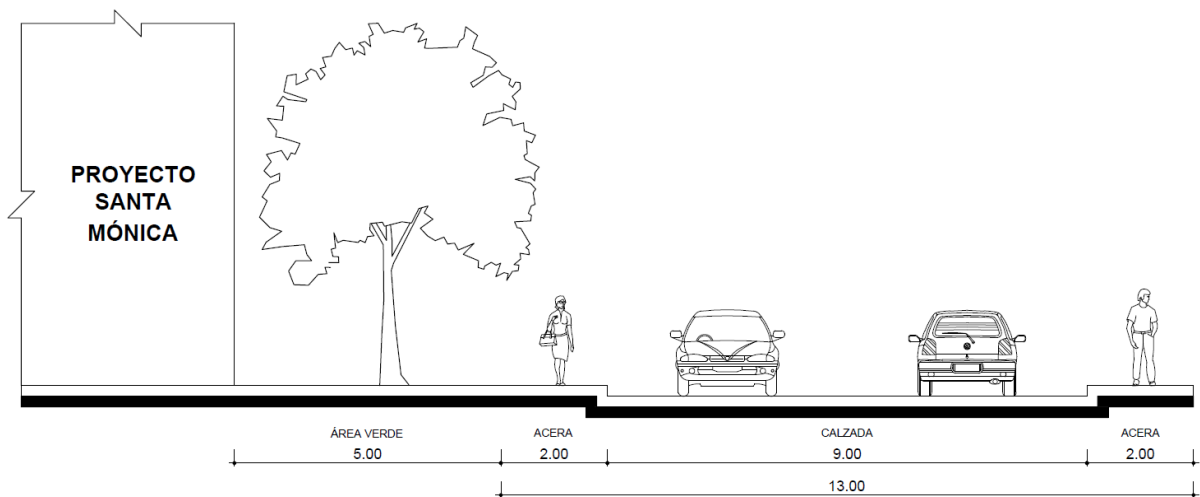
Sección transversal de la calle Huancavilca a la altura del proyecto en la situación actual
